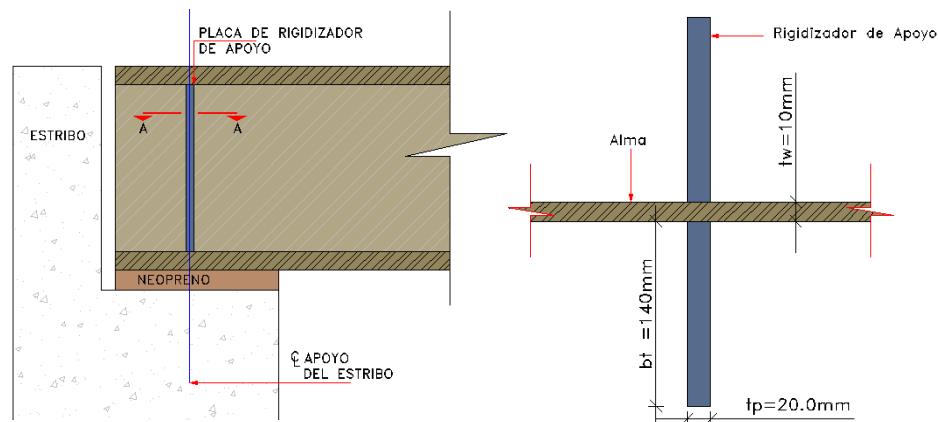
Configuración de los rigidizadores de apoyo en Elevación (Izquierda) y en Planta (Derecha)
